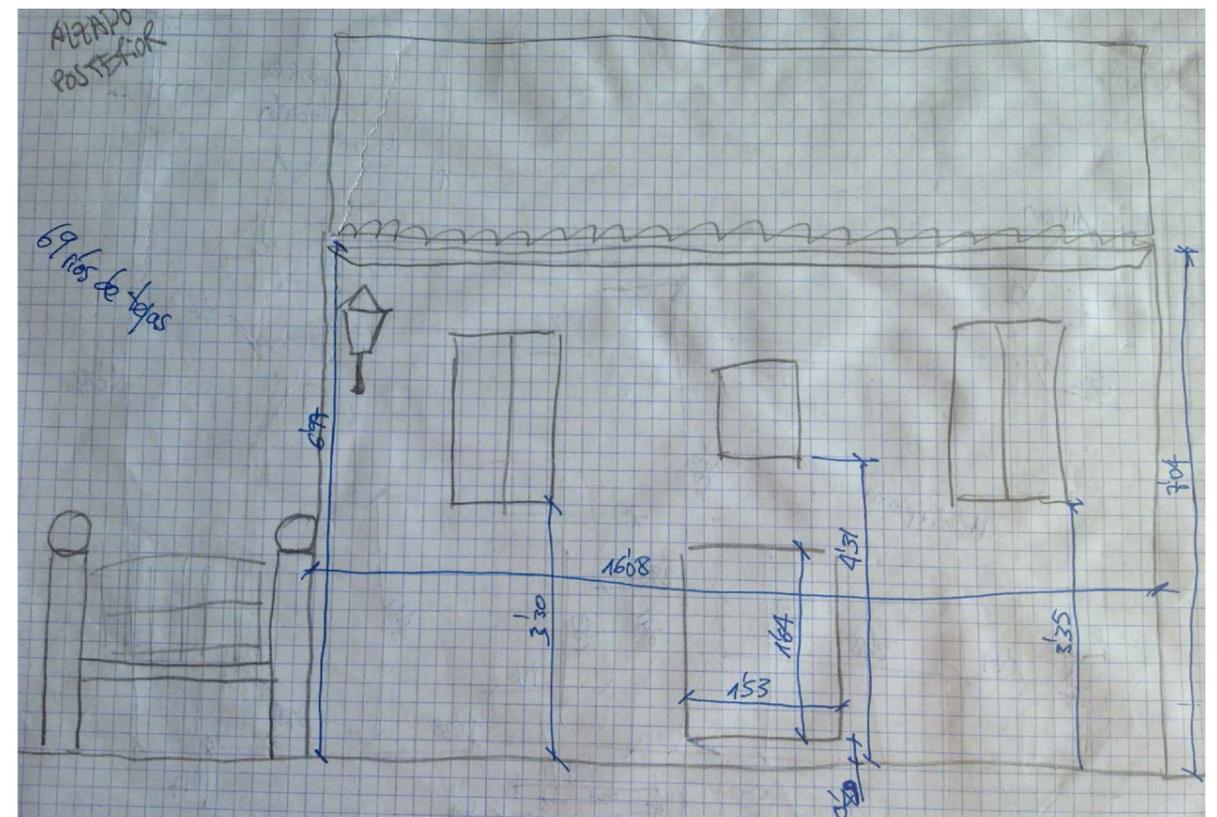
Fachada posterior (NW). 2014. Fuente: elaboración propia.
